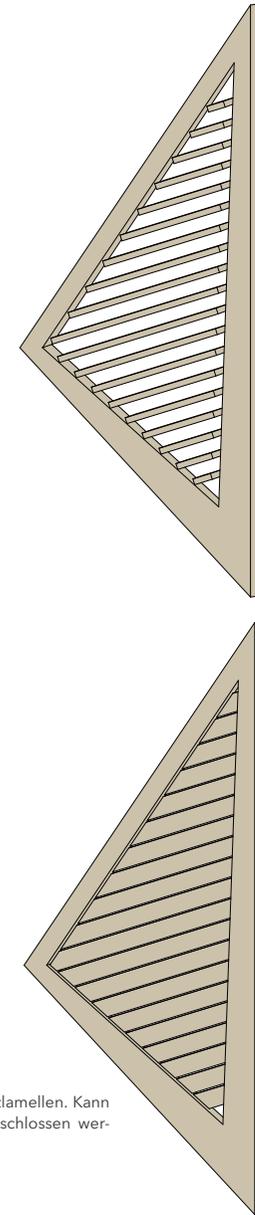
Holzlamellen. Kann je nach Bedarf geschlossen werden.
